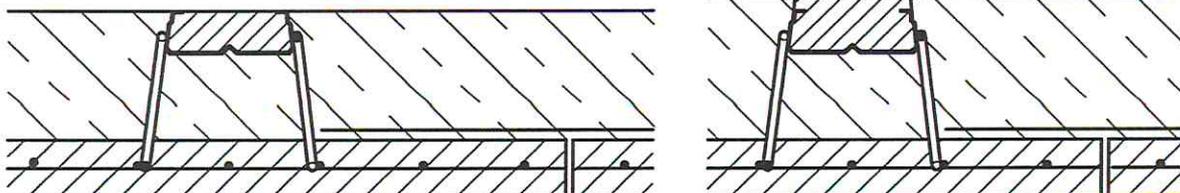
Oberkante Betongurt unter Oberkante Ortbeton
